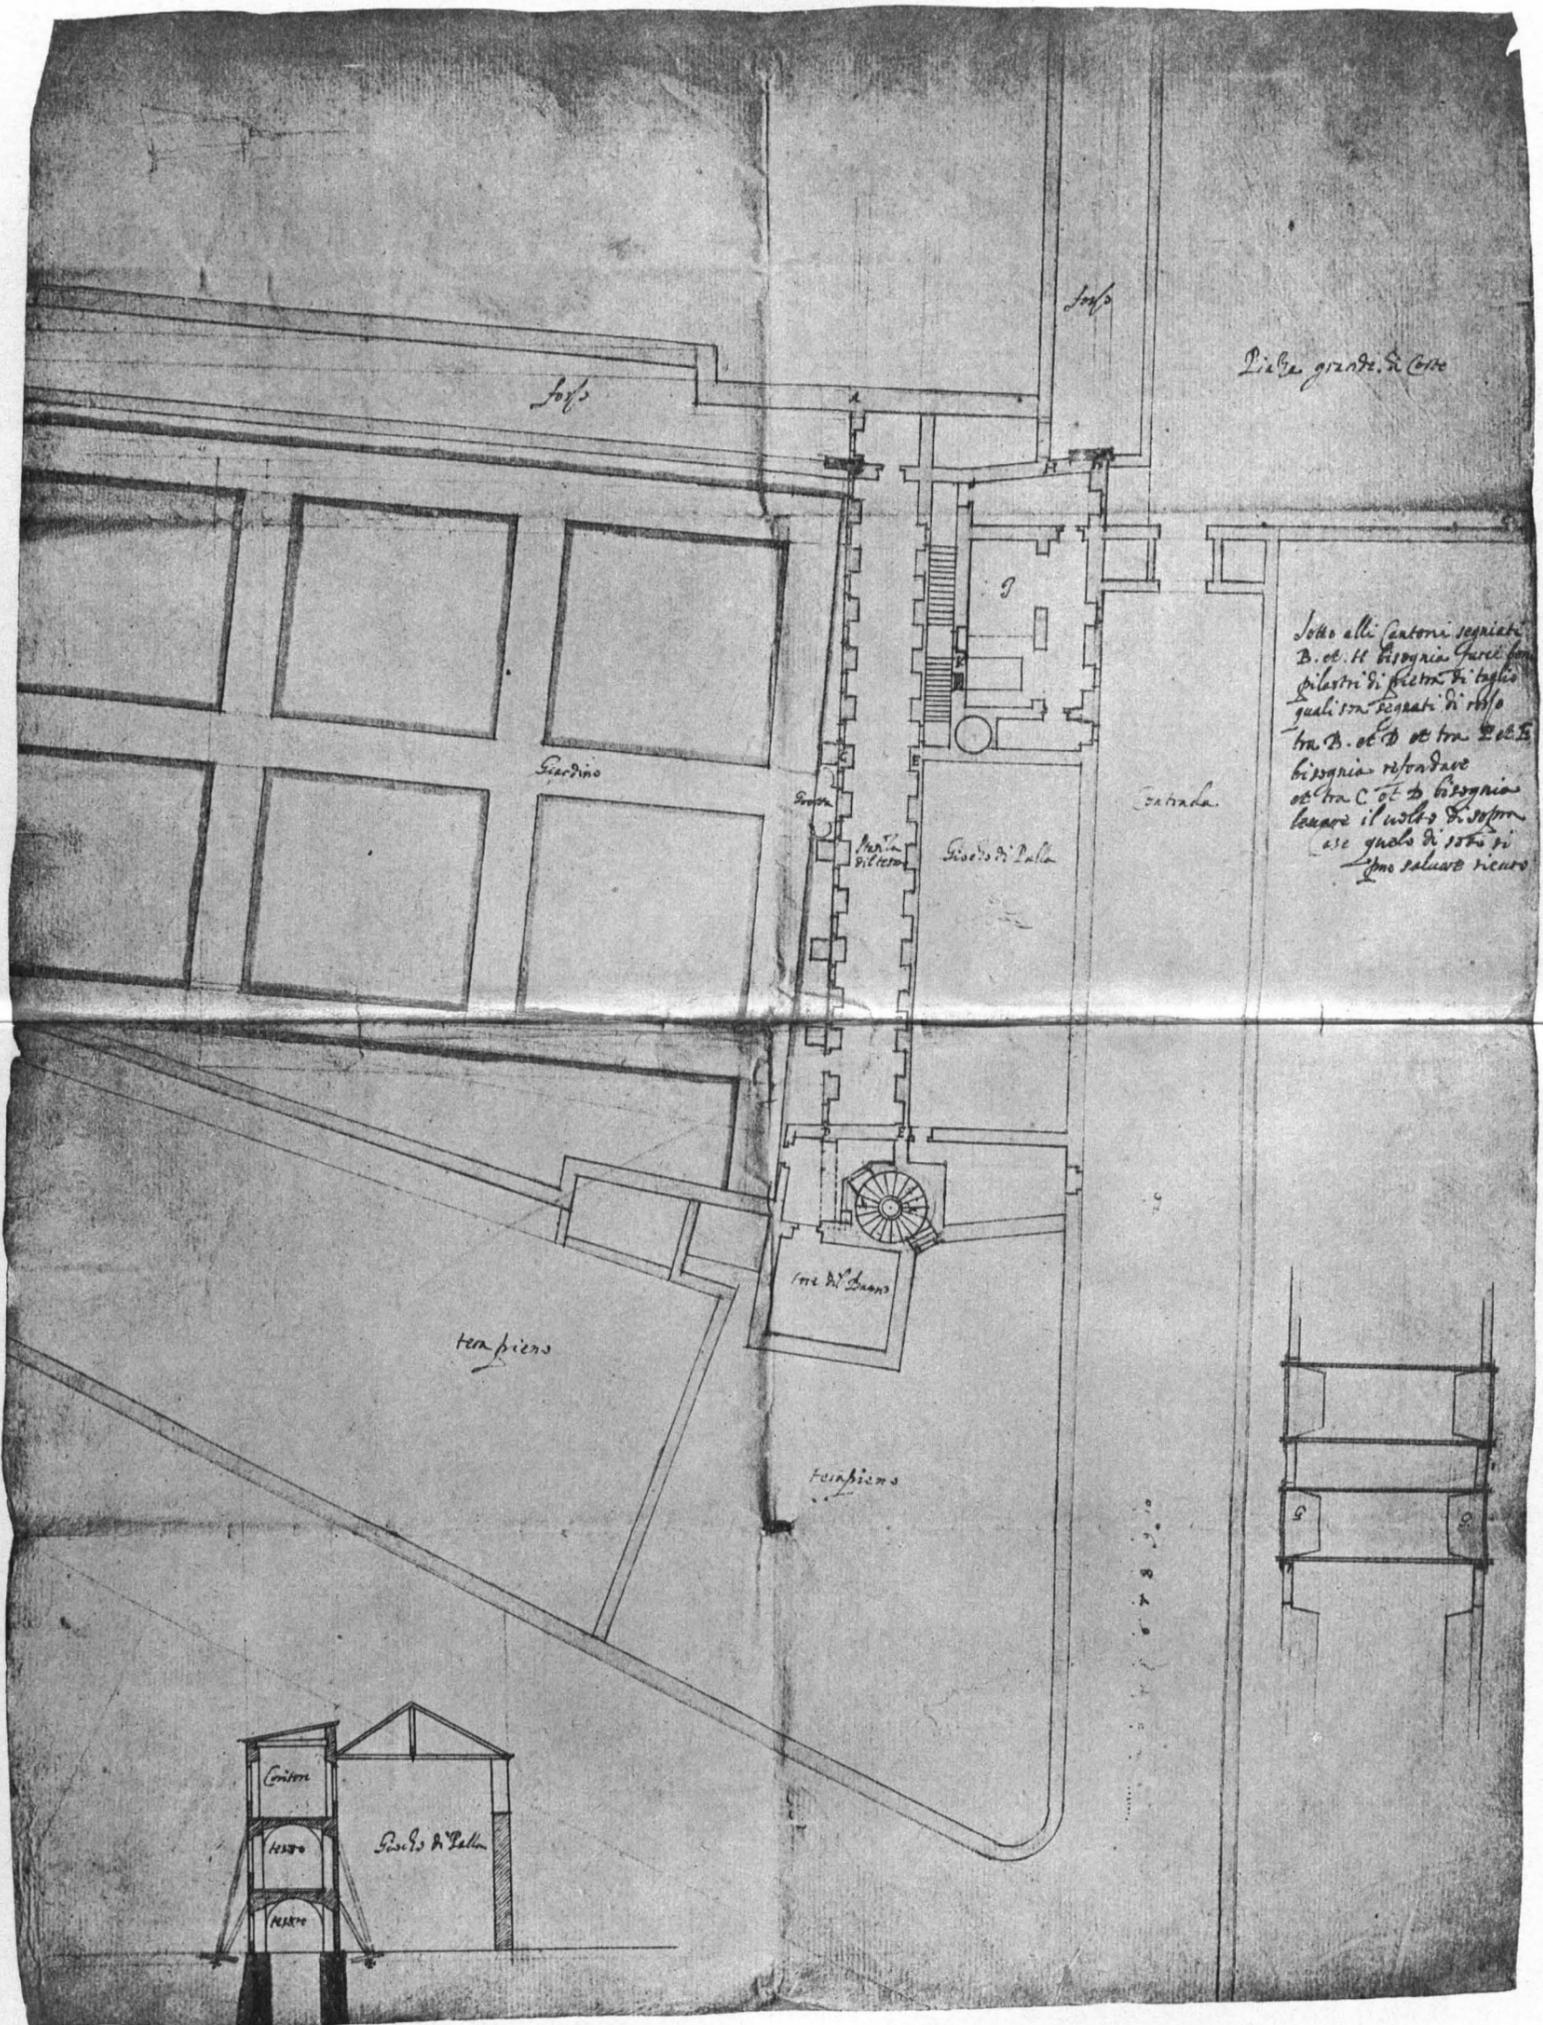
Grundriß des Hofgartens mit Ballhaus, aus den Jahren 1640—41, Federzeichnung, zum Teil farbig laviert, k. u. k. Gemeinsames Finanzarchiv
